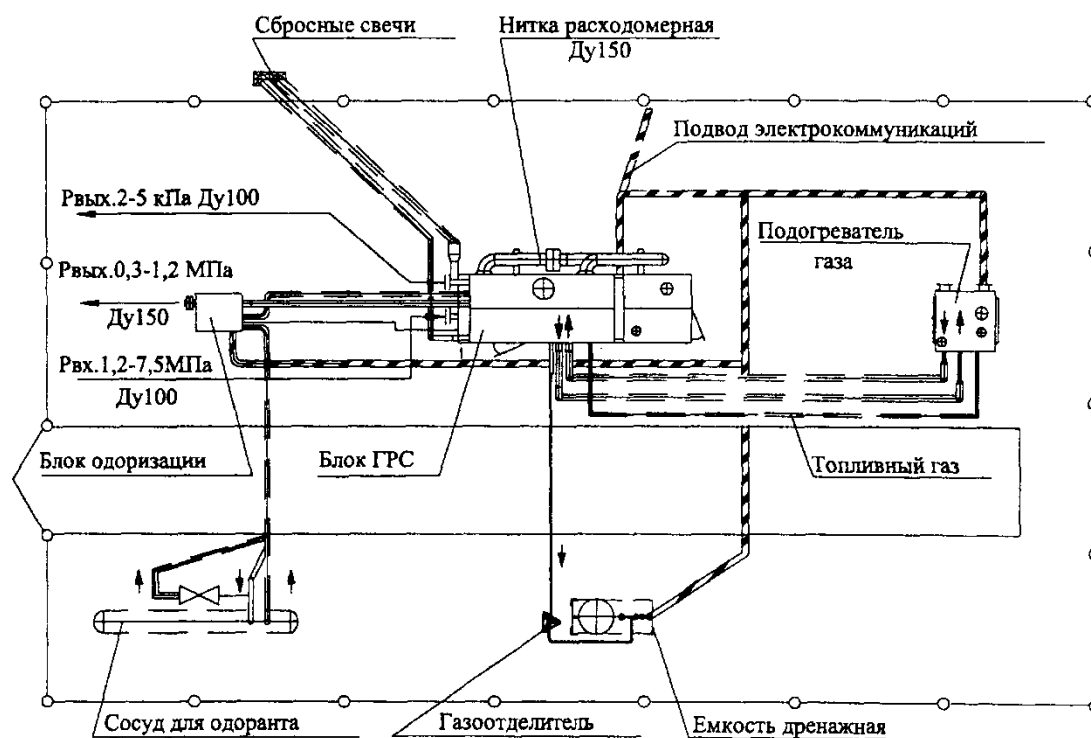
Схема размещения блоков станции "САРАТОВ-10" на площадке
